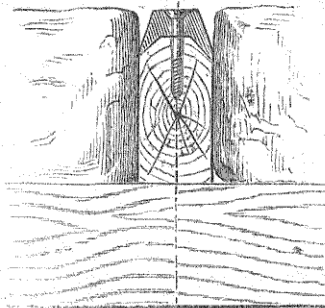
Rail en croissant de M. J. Noble. Échelle 1/8.
